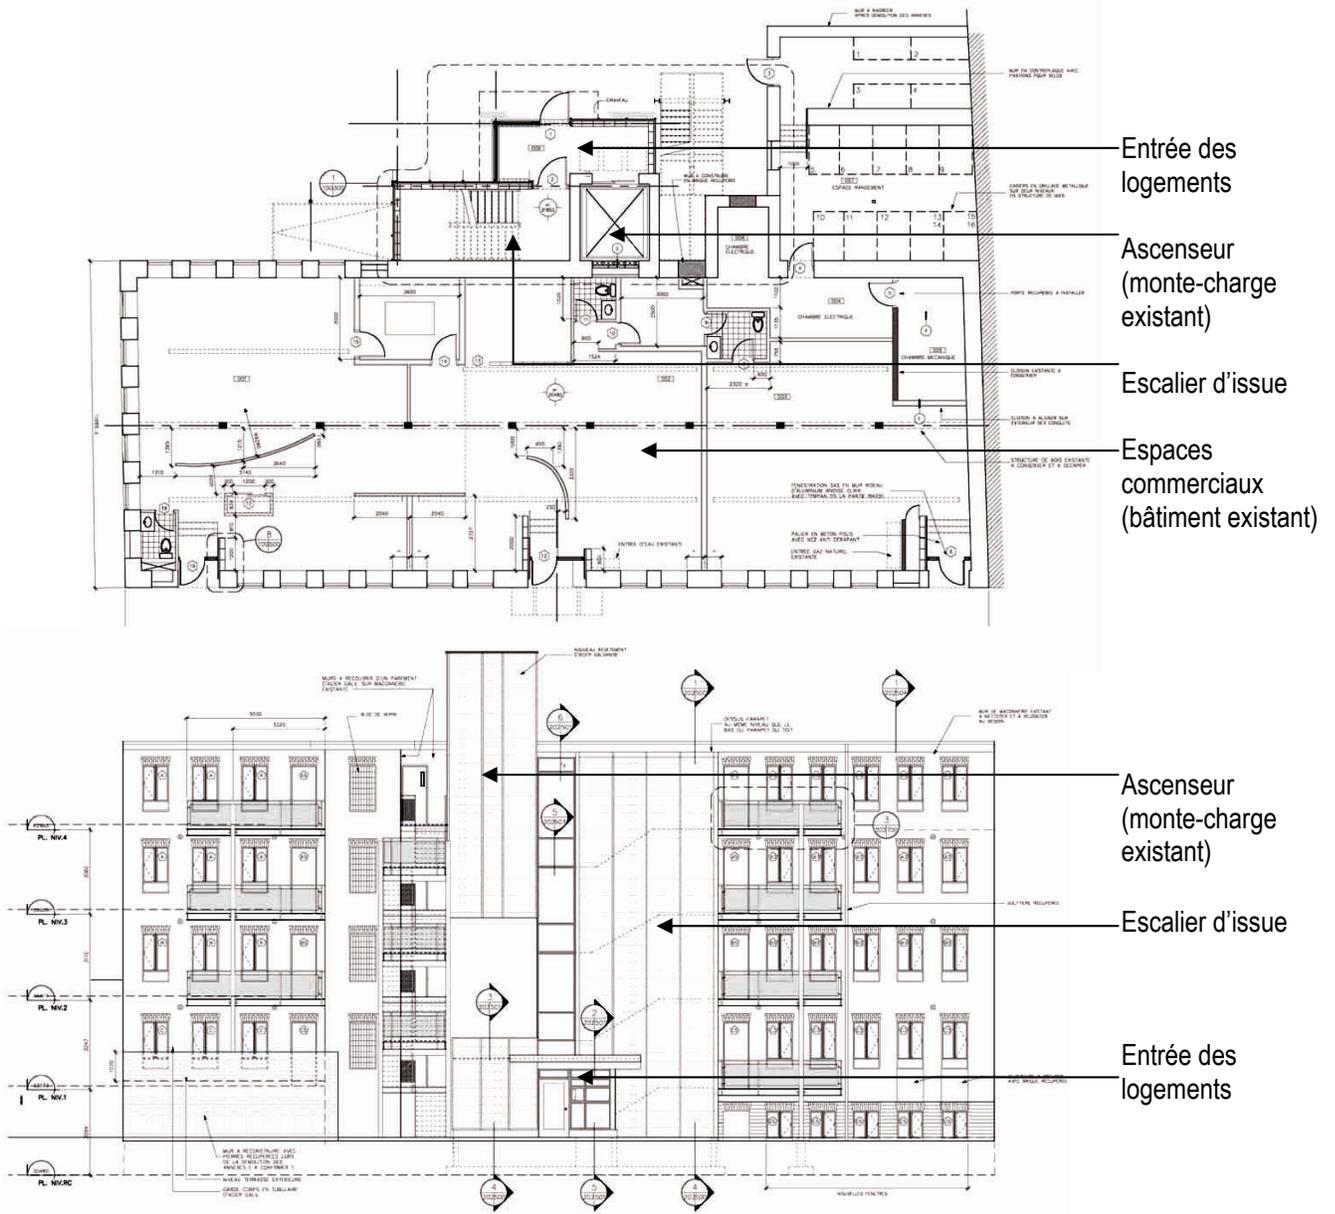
(A) Plan du rez-de-chaussée et (B) élévation sud (Source: Croft Pelletier Architectes)
